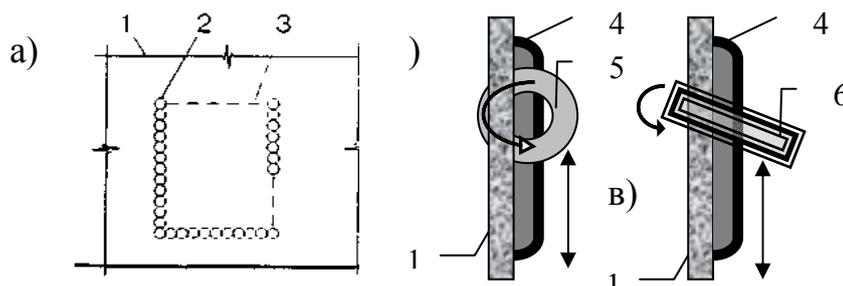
Современные способы создания отверстий и проемов в стене с использованием алмазного инструмента: а) - последовательность сверления, б) - резка дисковой пилой; в) - цепью или канатом: 1 - конструкция, 2 - отверстия, 3 - разметка, 4 – направляющие, 5 - алмазный диск, 6 - бесконечная цепь.
